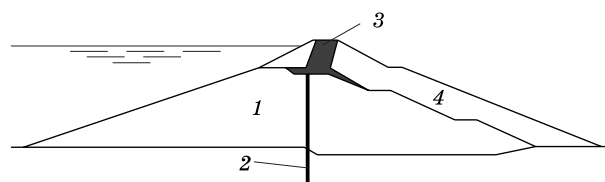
Реконструируемая плотина «Эль Хвез»: 1 – плотина до реконструкции; 2 – стена в грунте; 3 – ядро; 4 – плотина после реконструкции
